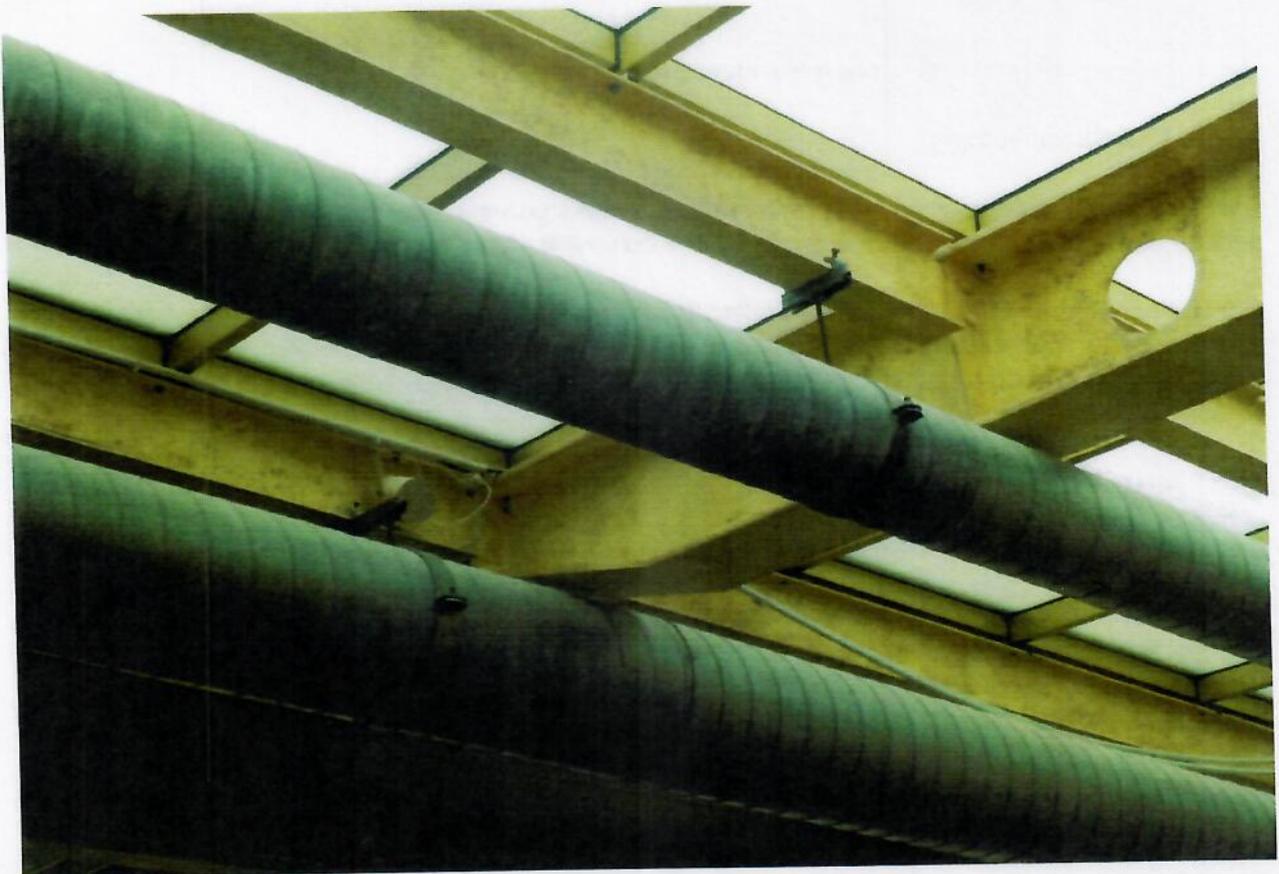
Lüftung 11: Korrodierte Lüftungshalterungen Bereich Lagune I
